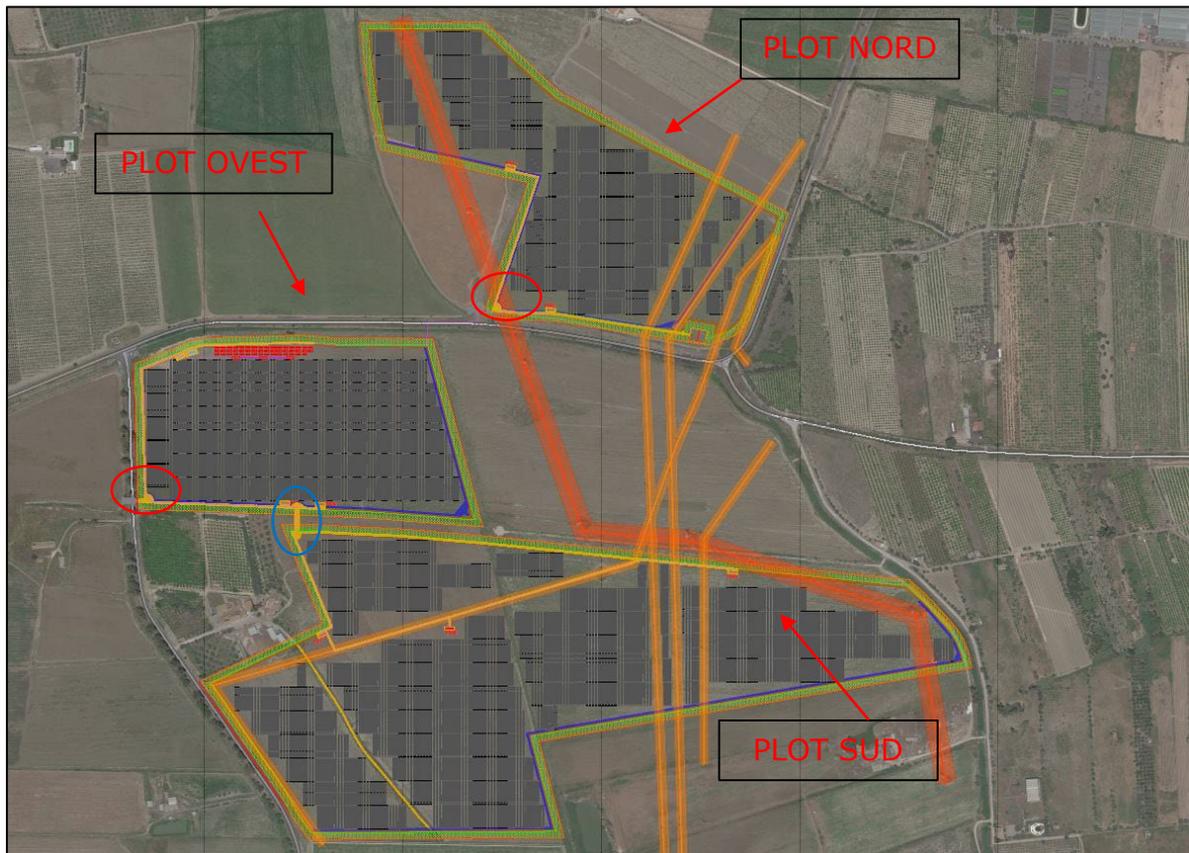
Estratto della Tavola Layout impianto su Ortofoto
